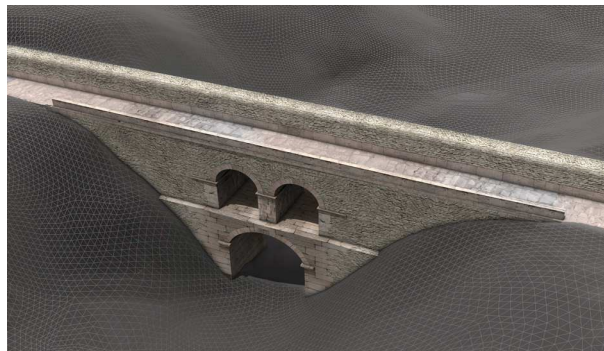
Ricostruzione del prospetto est e della parte superiore della spalla sud del ponte-acquedotto.
